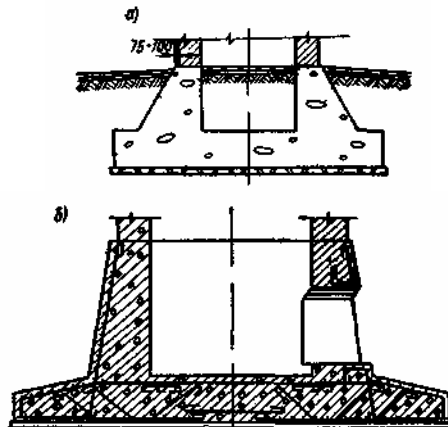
Фундаменти цегельних димарів: *a* – бетонний; *б* – залізобетонний
